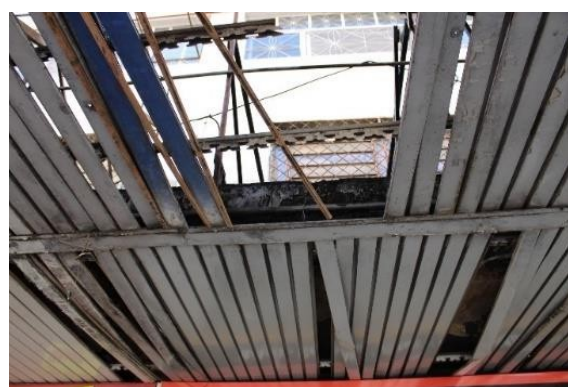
e 24 : Acabamentos “camuflando” a situação de degradação das marquises
